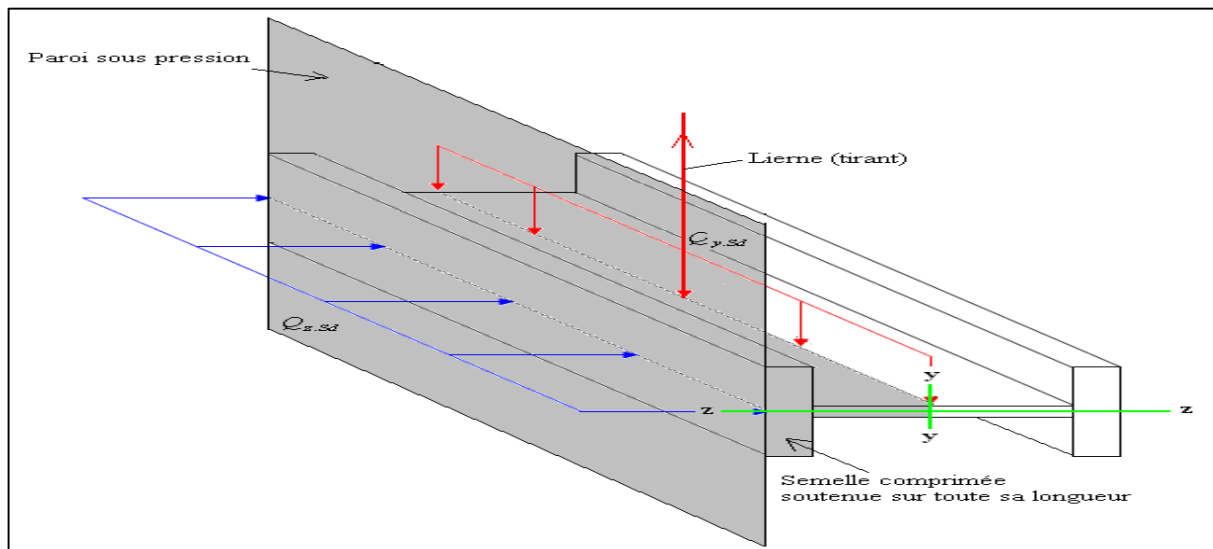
Semelle comprimée soutenue sur toute sa longueur.
